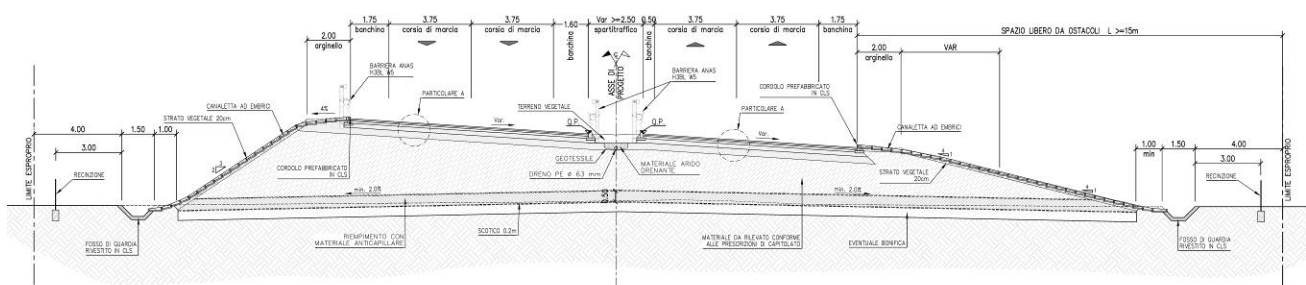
Sezione tipo in rilevato dell'asse principale con corsia di diversione e allargamento per visibilità
